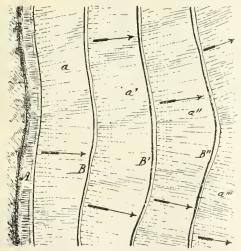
Coupe transversale et plan des rigoles de niveau sur un terrain à forte pente.
